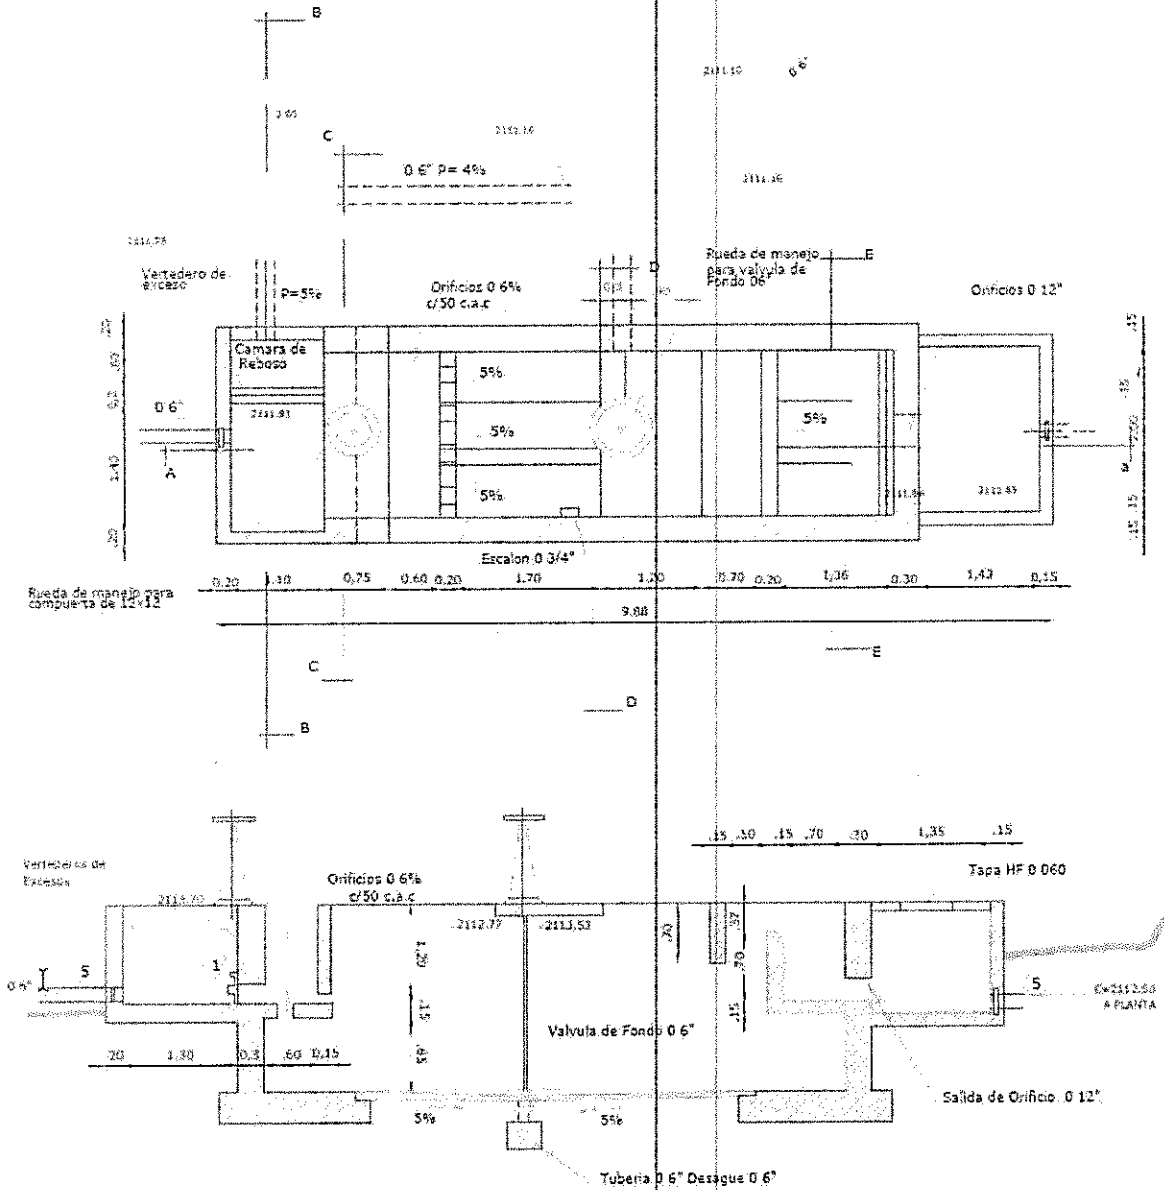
Plano detalle desarenador aducción PTAP Marmato
